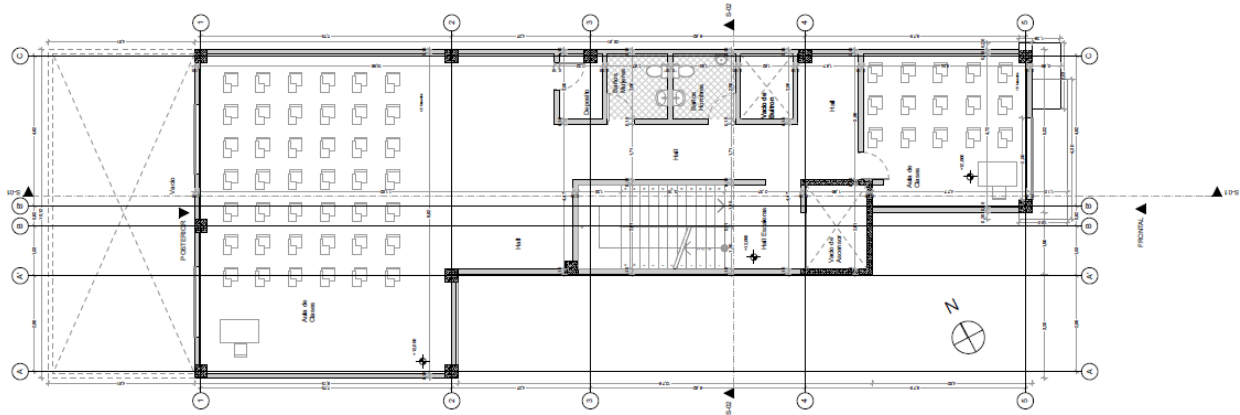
Planta Arquitectónica 4 Primer Piso Actual Cafaba.
